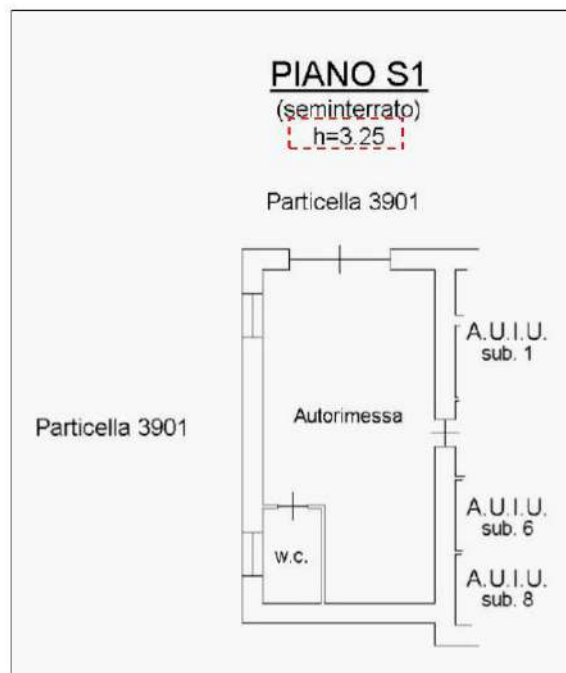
Planimetria castale Autorimessa (Sub. 2)
